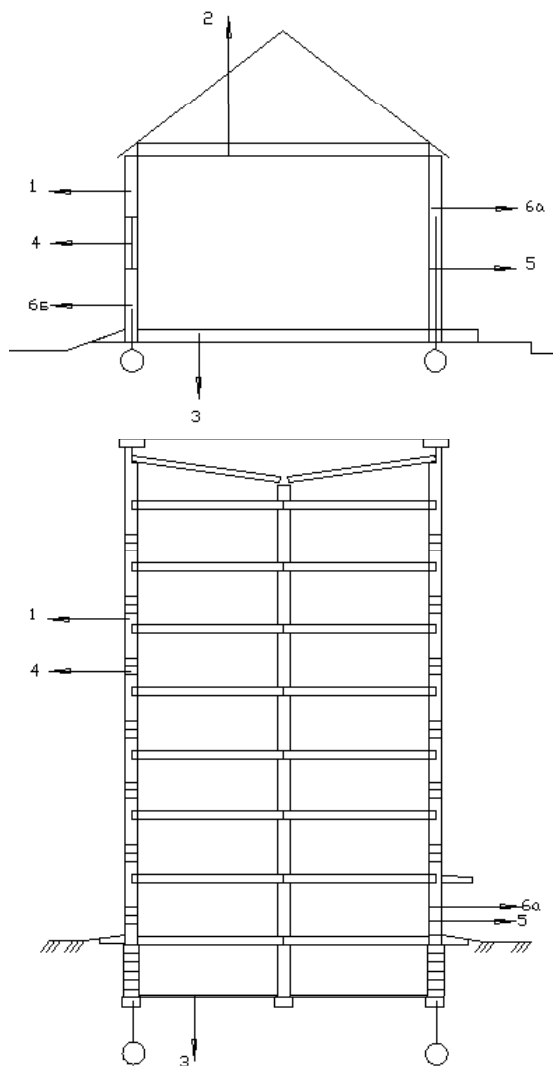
Теплотери в зданиях: а – одноэтажных; б – многоэтажных; 1 – через наружные стены; 2 – через чердачные перекрытия; 3 – через полы по грунту или холодные надподвальные перекрытия; 4 – через окна; 5 – через входные двери; 6 – через открывающиеся проемы
